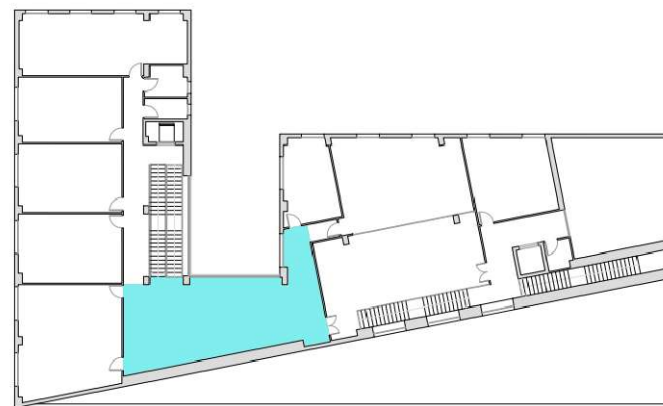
Planta Primera y Espacios de Exposición Pasillo [Plano 2]
